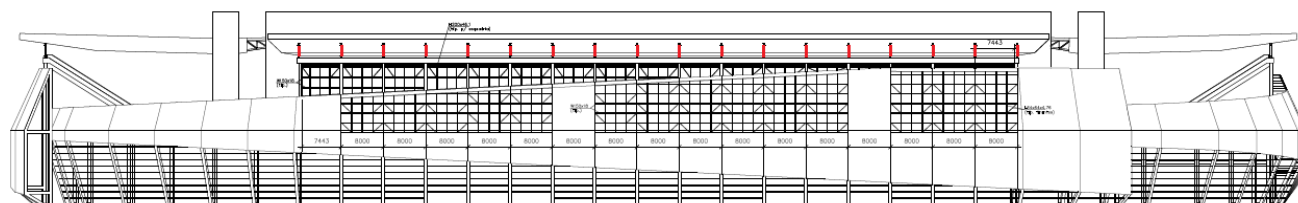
Pilares de apoio da cobertura Leste/Oeste.
